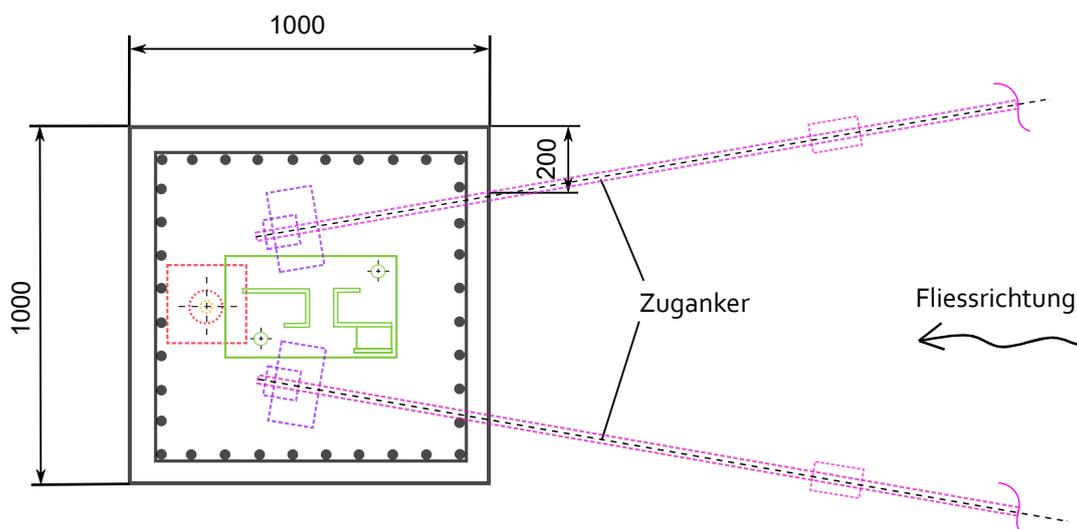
Draufsicht eines bewerten Betonfundamentes mit einem Druck- und 2 Zugankern in Anlehnung an [15].
